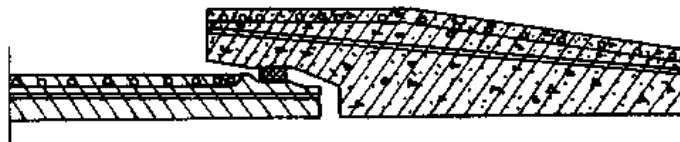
三阶段工艺钢筋混凝土管道柔性接口
